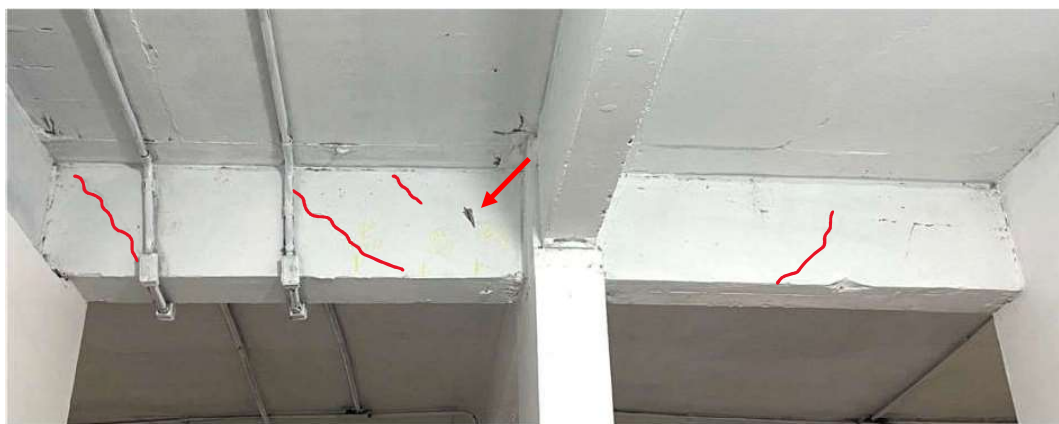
Fissuras inclinadas em viga e armadura exposta e corroída.
